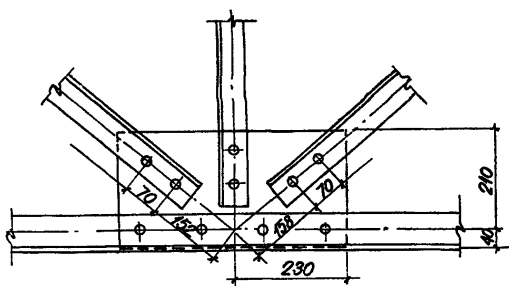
Промежуточный узел нижнего пояса клепаной стропильной фермы
